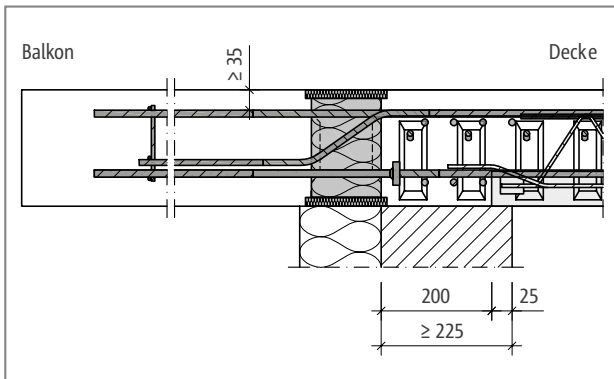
Schöck Isokorb® XT Typ C: Elementplatte ohne Randunterstützung mit WDVS (Schnitt XT Typ C-L-CV35, Ansicht XT Typ C-R-CV50)
